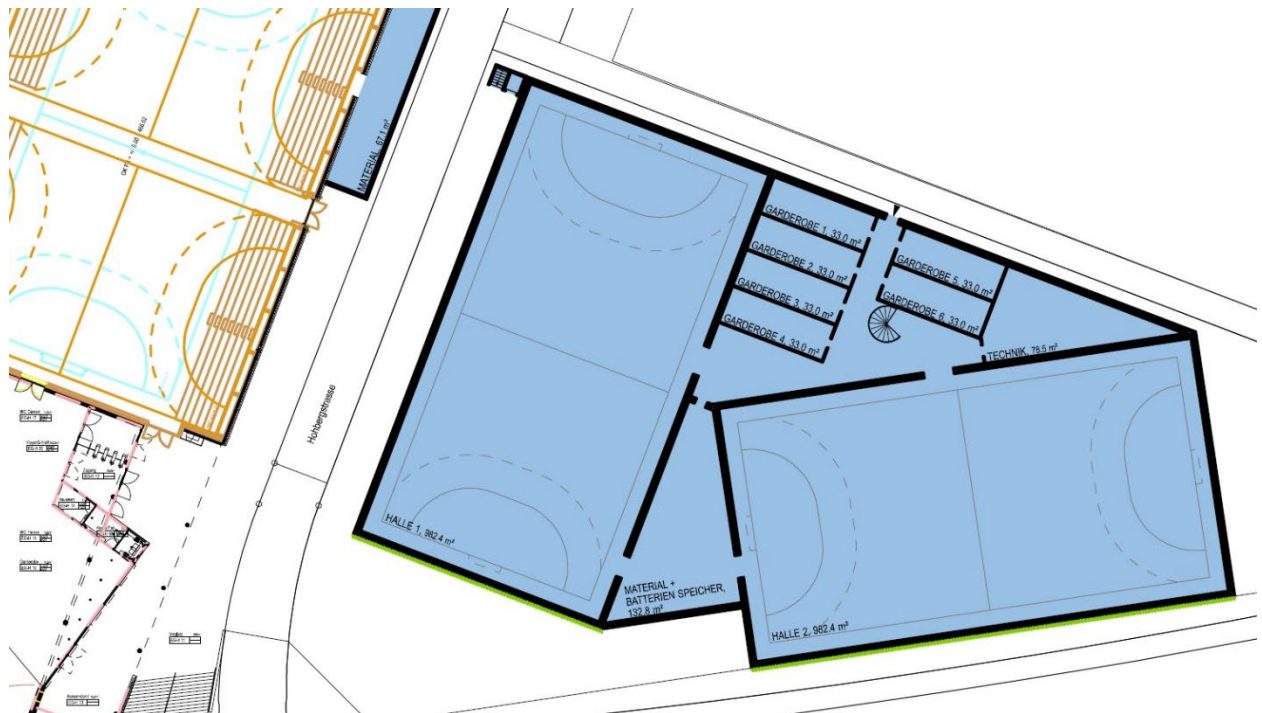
Grundriss Erdgeschoss Neubau Ost
